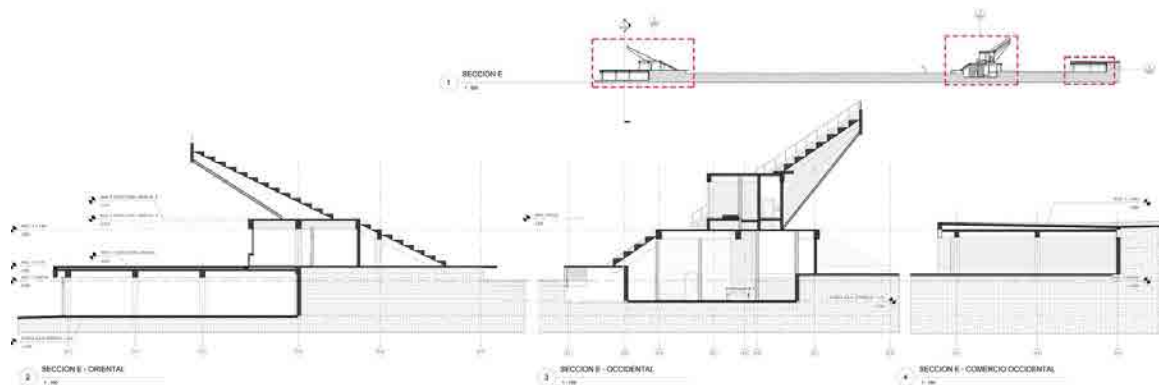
Sección constructiva. Fuente: www.plataformaarquitectura.cl/
